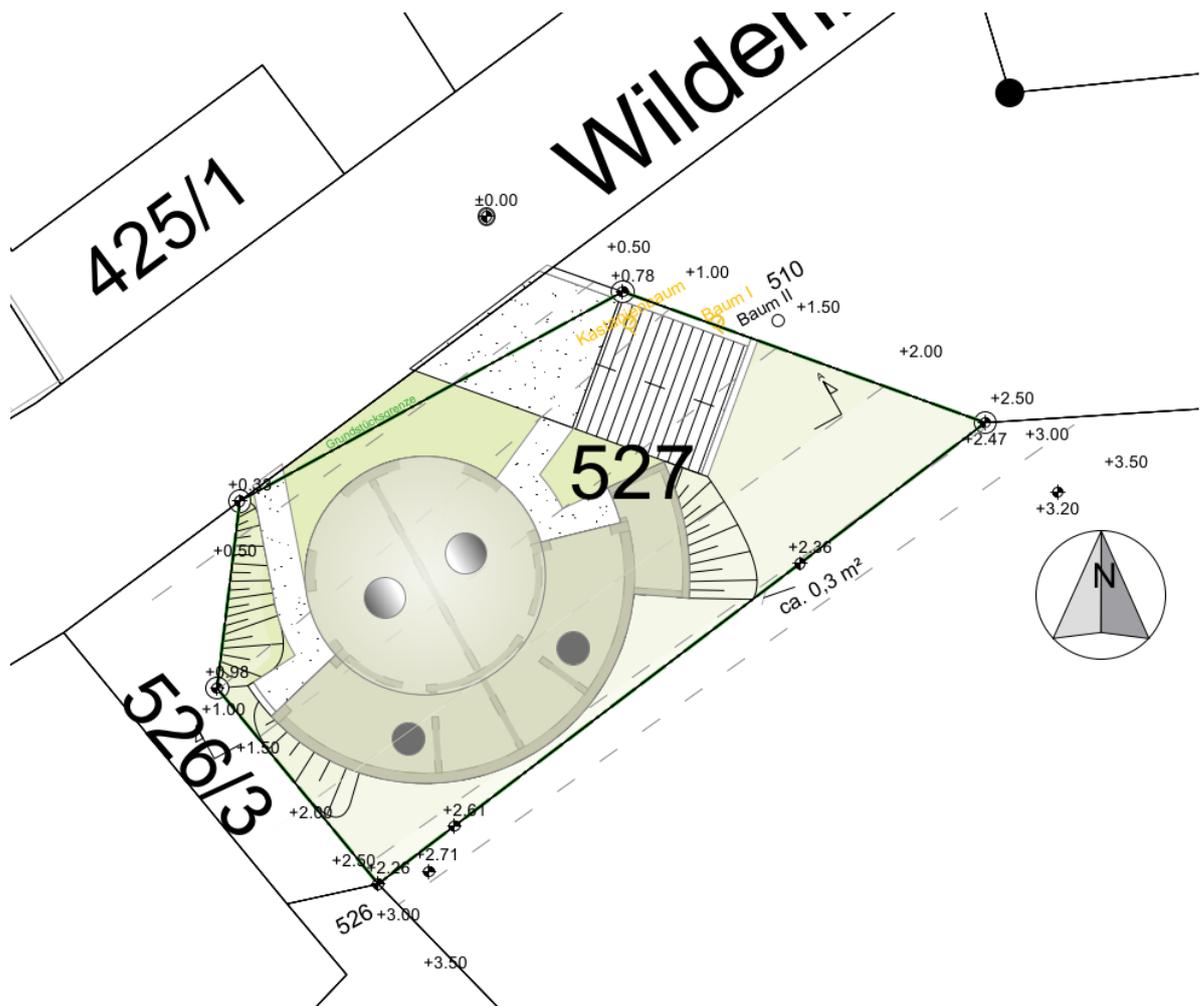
, Grundstück mit Dachansicht und Höhenverlauf
